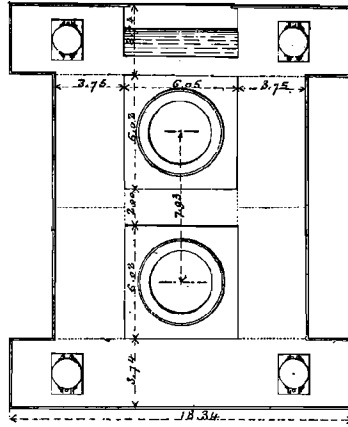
Plan de la plate-forme. Echelle de 1/300.
